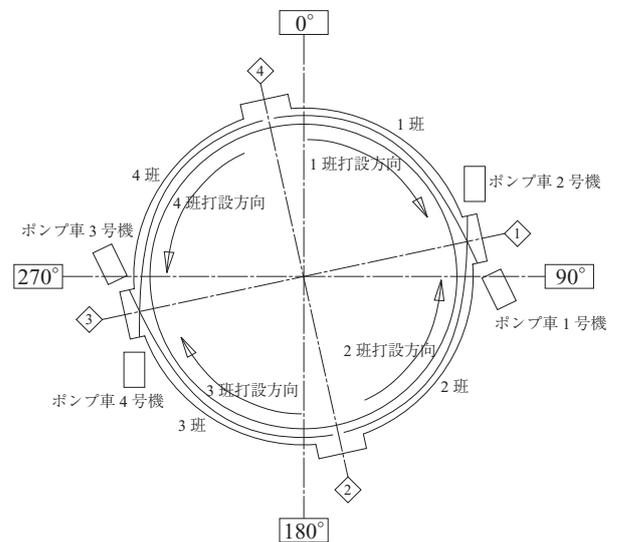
防液堤 #5～15 ロットコンクリートポンプ車配置図
